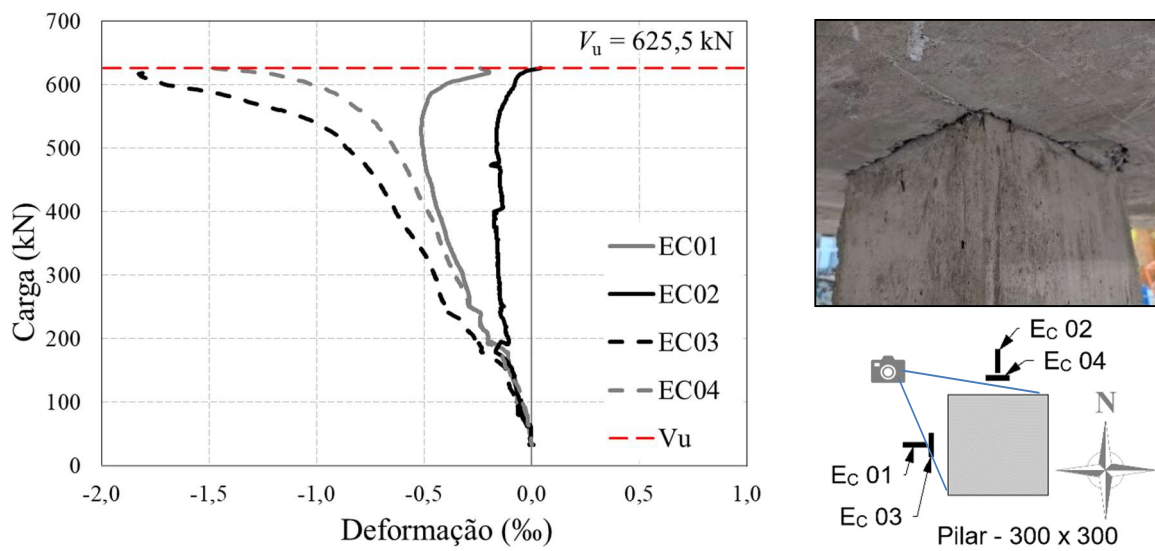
Deformações da superfície de concreto na laje CTA
